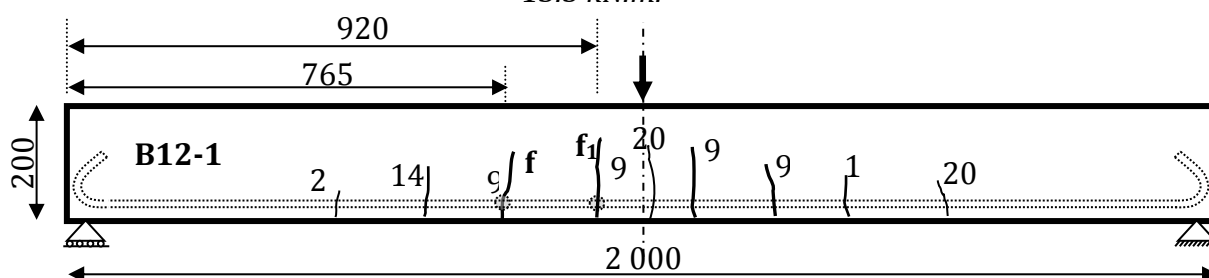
Cartes des fissurations de la poutre B12-1 au niveau de pré-chargement de 13.5 kN.m.
